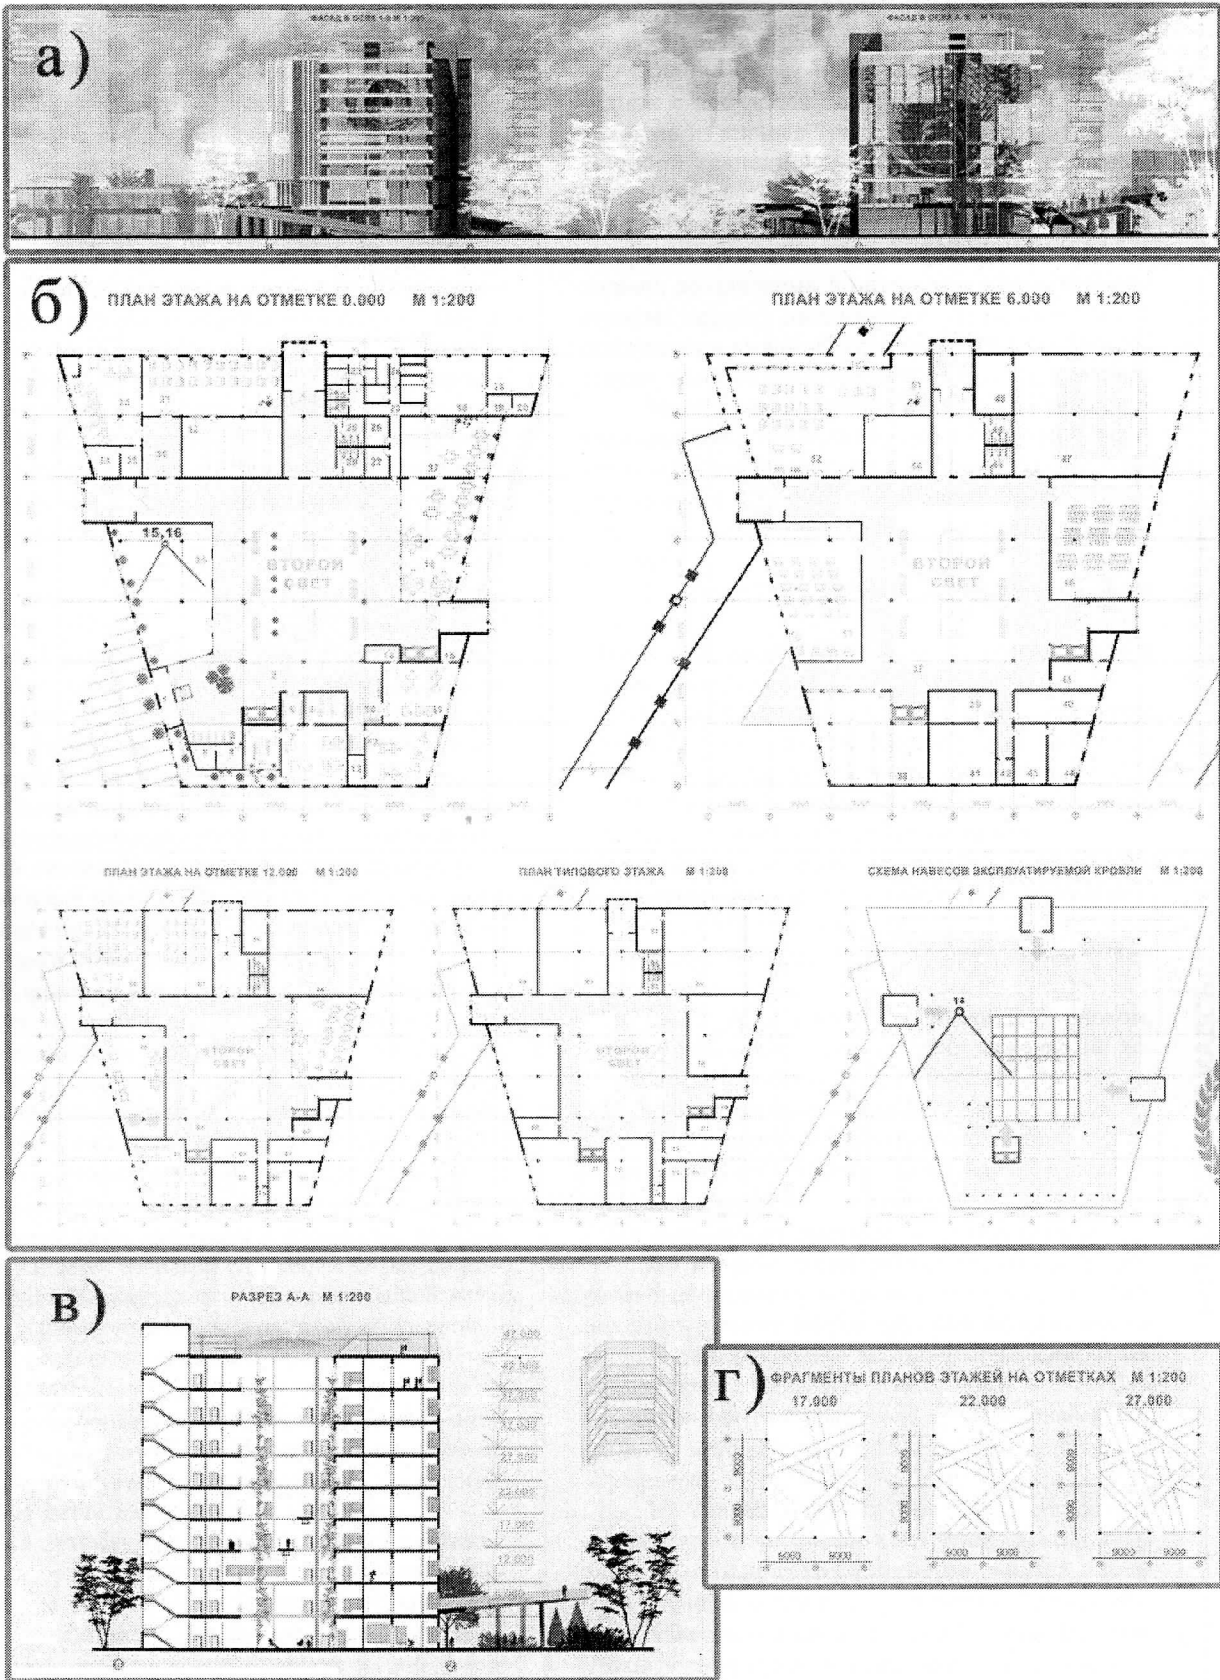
а) Визуализации фасадов б) Планы этажей в) Разрез г) Фрагменты планов этажей (решение в плане триумного пространства с переходами)
